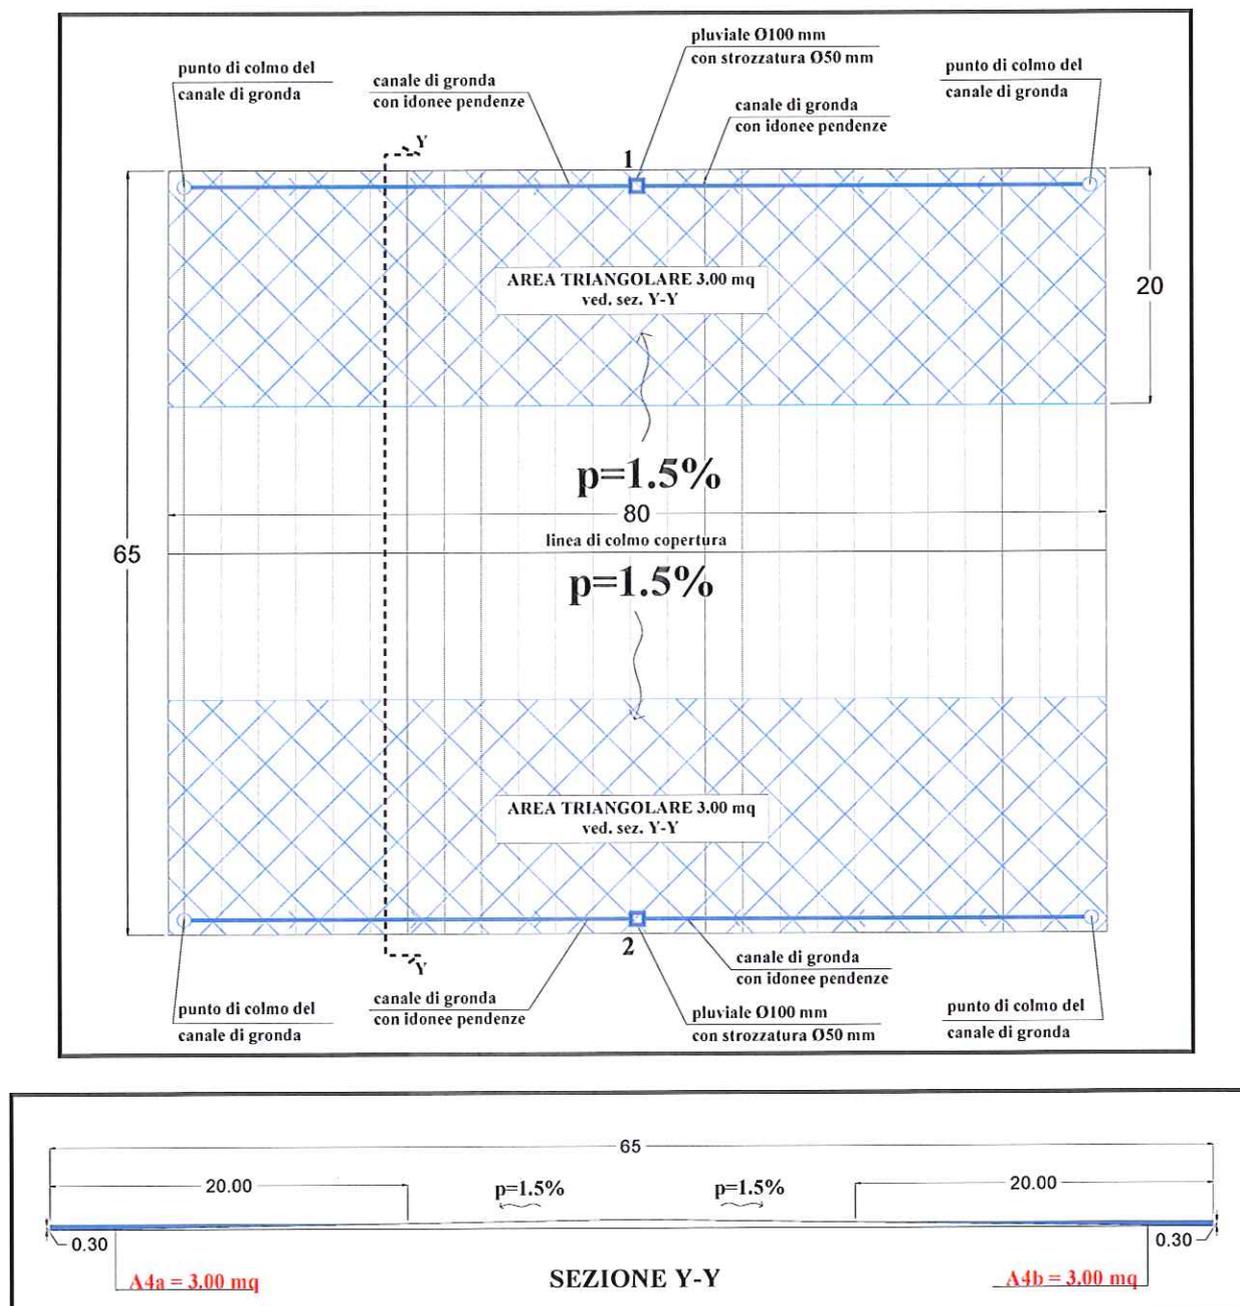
Pianta e sezione trasversale Y-Y della copertura edificio 4
